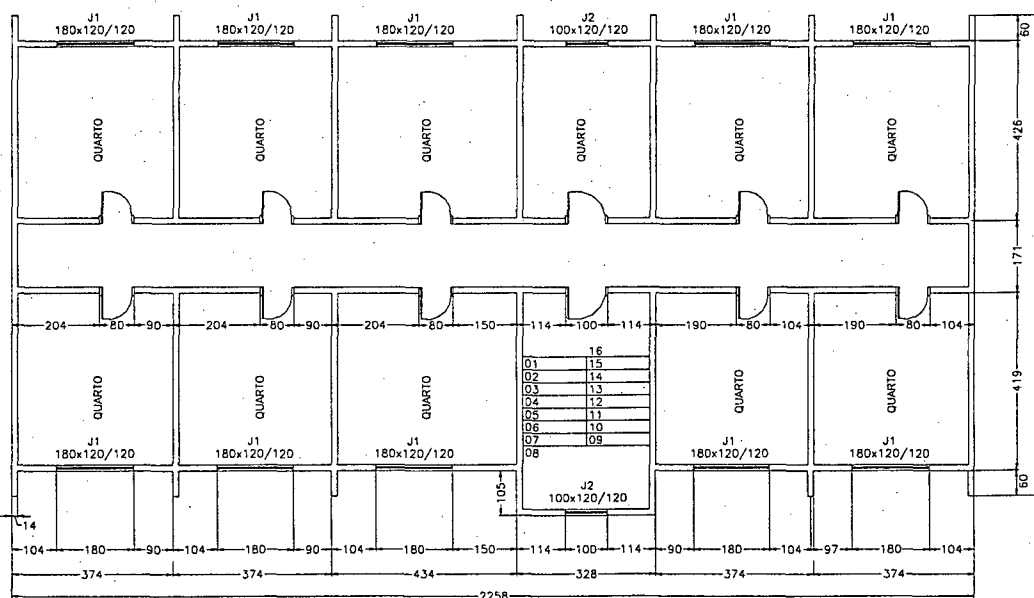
Planta baixa do pavimento tipo do edifício da moradia estudantil da UFSC
